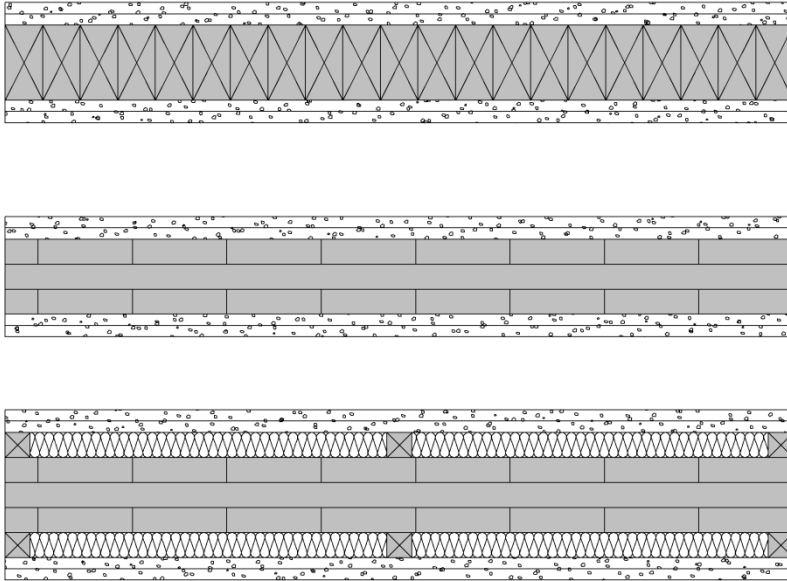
Beispiele für Wandbauweisen aus Massivholz (Massivholzwand, Brettsper Holz). Die Bauweisen sind nach M-HFHolzR nicht zulässig, da die Richtlinie nicht für Wandkonstruktionen aus Massivholz gültig ist.
